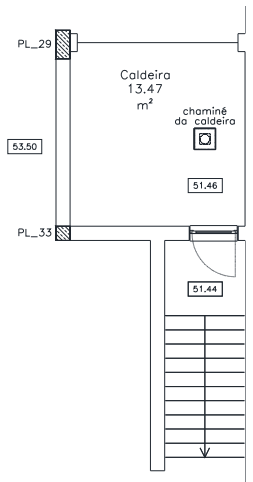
Esquema da galeria técnica junto aos pilares PL\_29 e PL\_33
